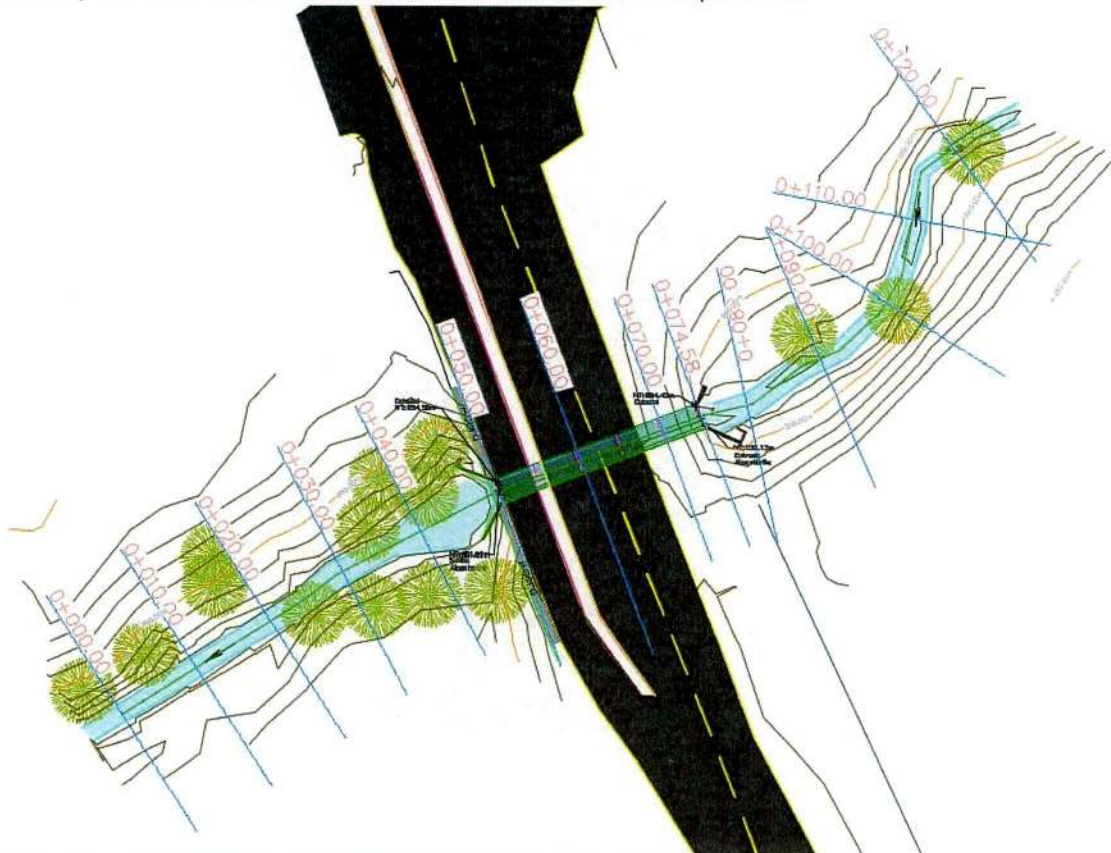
Levantamiento topográfico realizado en el sitio de la alcantarilla en la Quebrada Pilas
